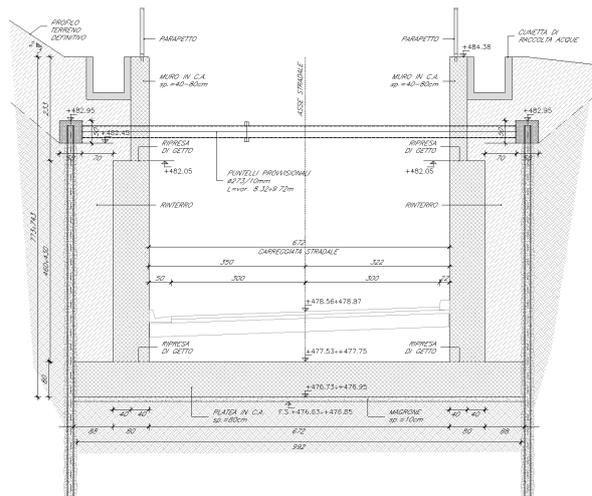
Sezione trasversale del muro di rampa RE-01 e RO-01
